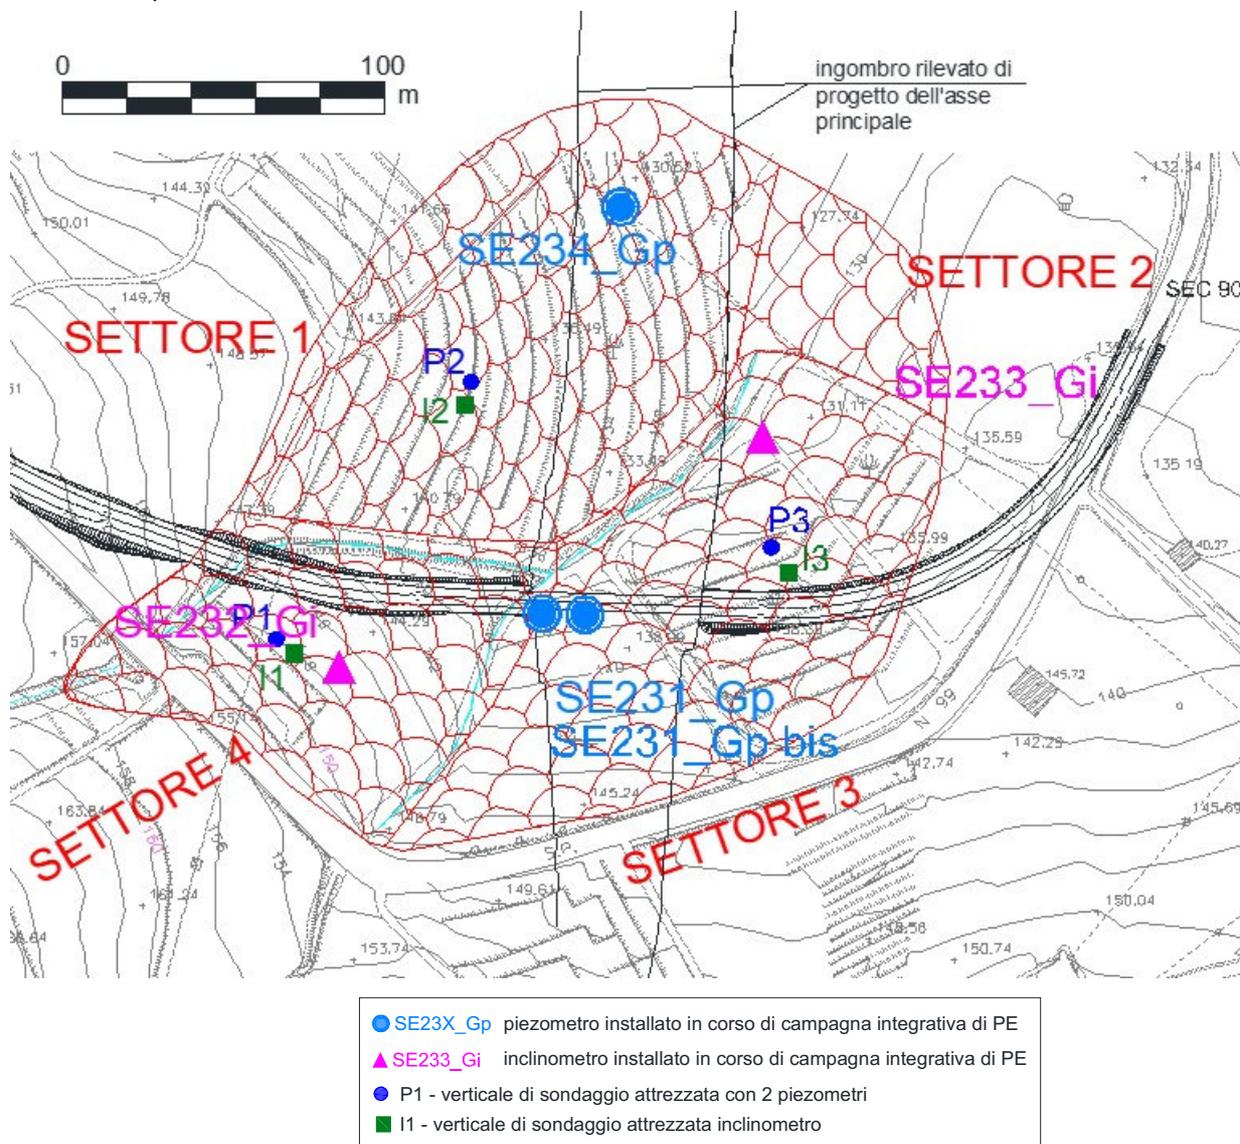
Planimetria con ubicazione della strumentazione di monitoraggio.
